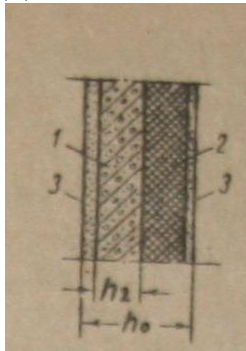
Залізобетонна стіна з утеплювачем. 1 – залізобетонна стіна товщиною ; 2 – плитковий утеплювач товщиною 70мм ($\gamma=400$); 3 – штукатурка товщиною 10мм ($\gamma=1600$).
